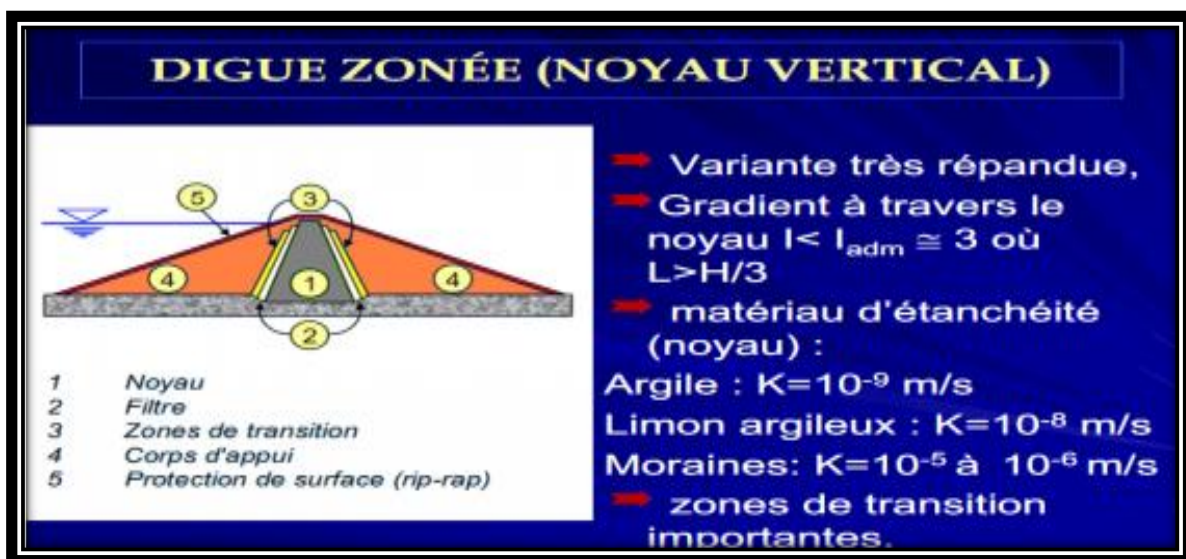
barrage à noyau central (Benkaci, 2014)
